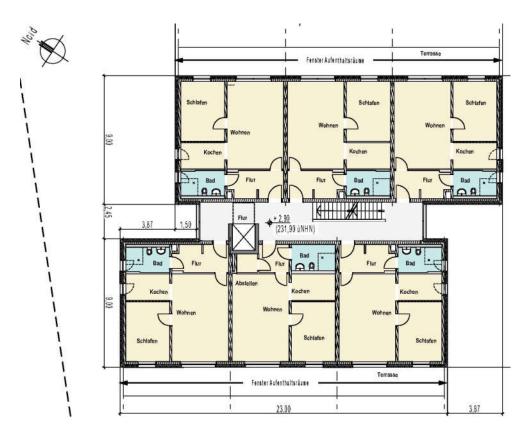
Grundriss 1. Obergeschoss / Betreutes Wohnen
